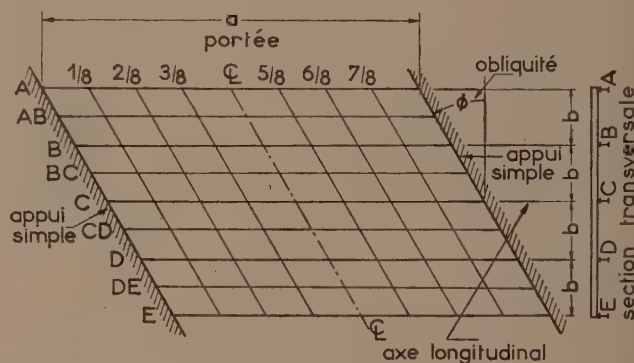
Schéma d'un pont-dalle biais (d'après MM. Chen-Siess-Newmark).
